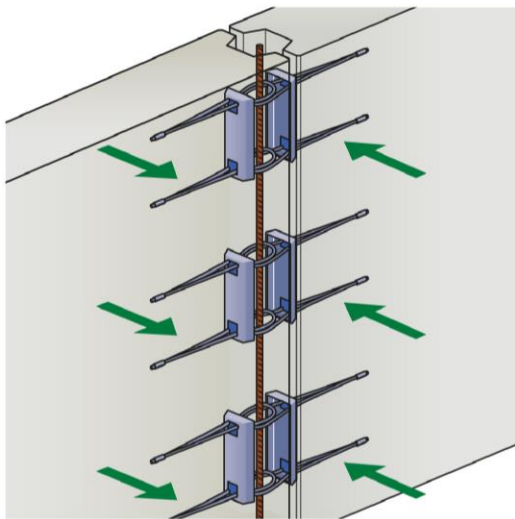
Beanspruchung senkrecht zur Fugenlängsrichtung und Wandebene
